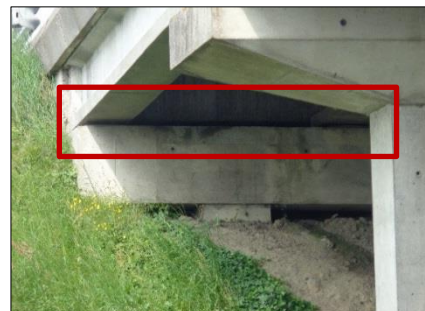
Joint de chaussées sur un pont de type (1) (CAPITANIO, 2018)
